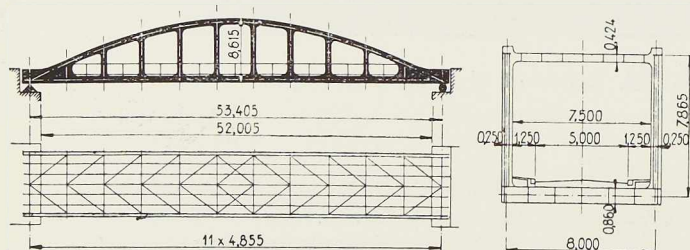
Elévation, plan et coupe du pont Vierendeel.
